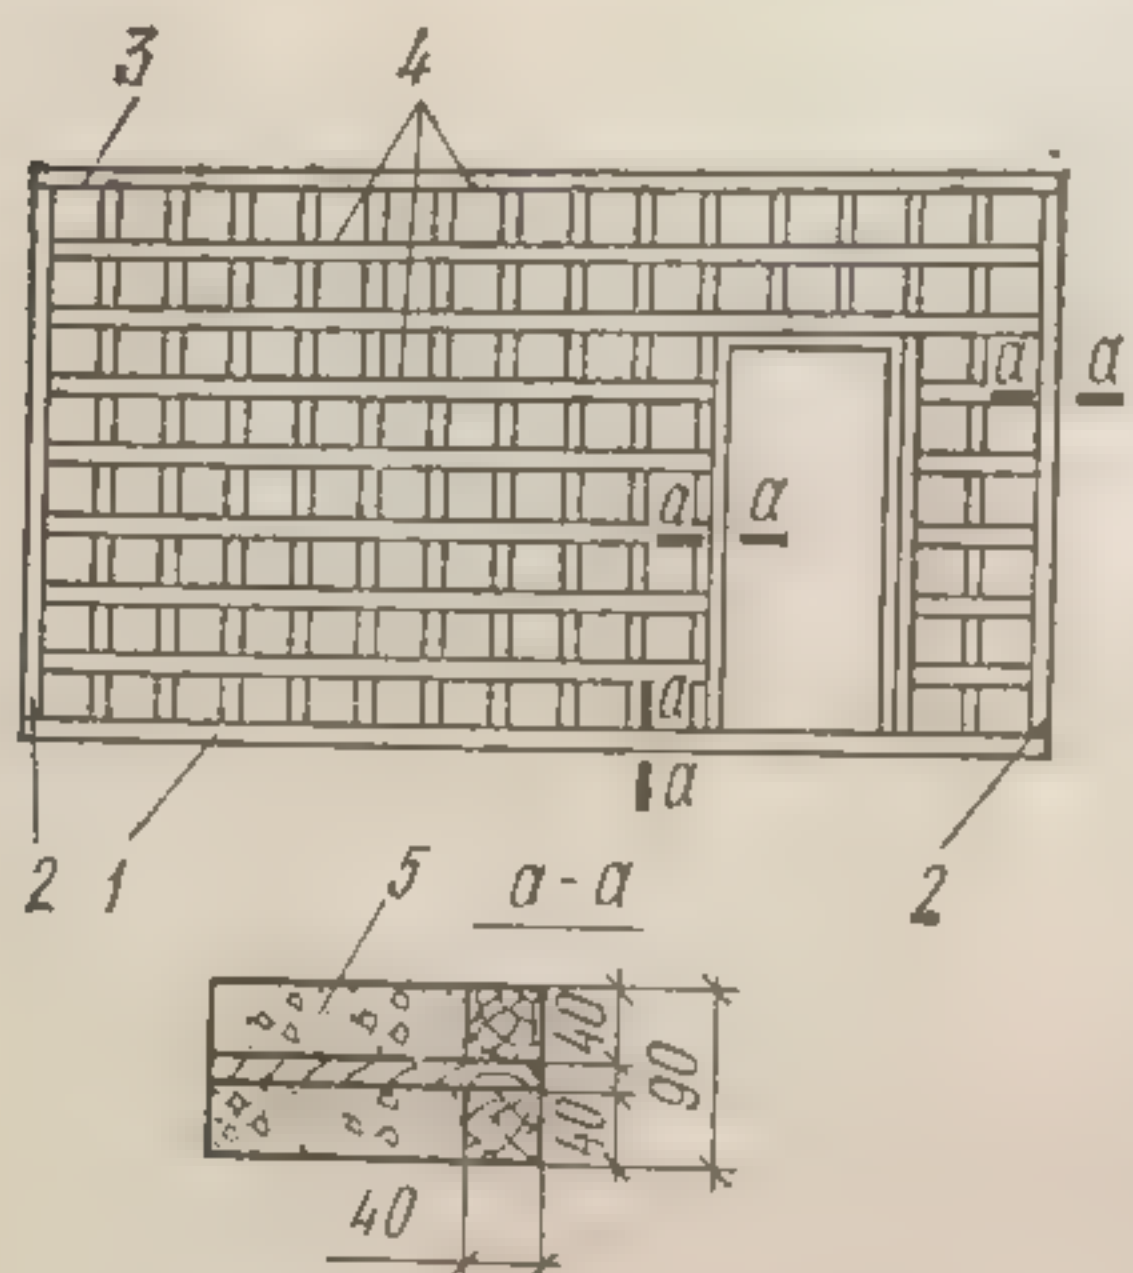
Схема деревянного каркаса гипсобетонной перегородочной панели:
